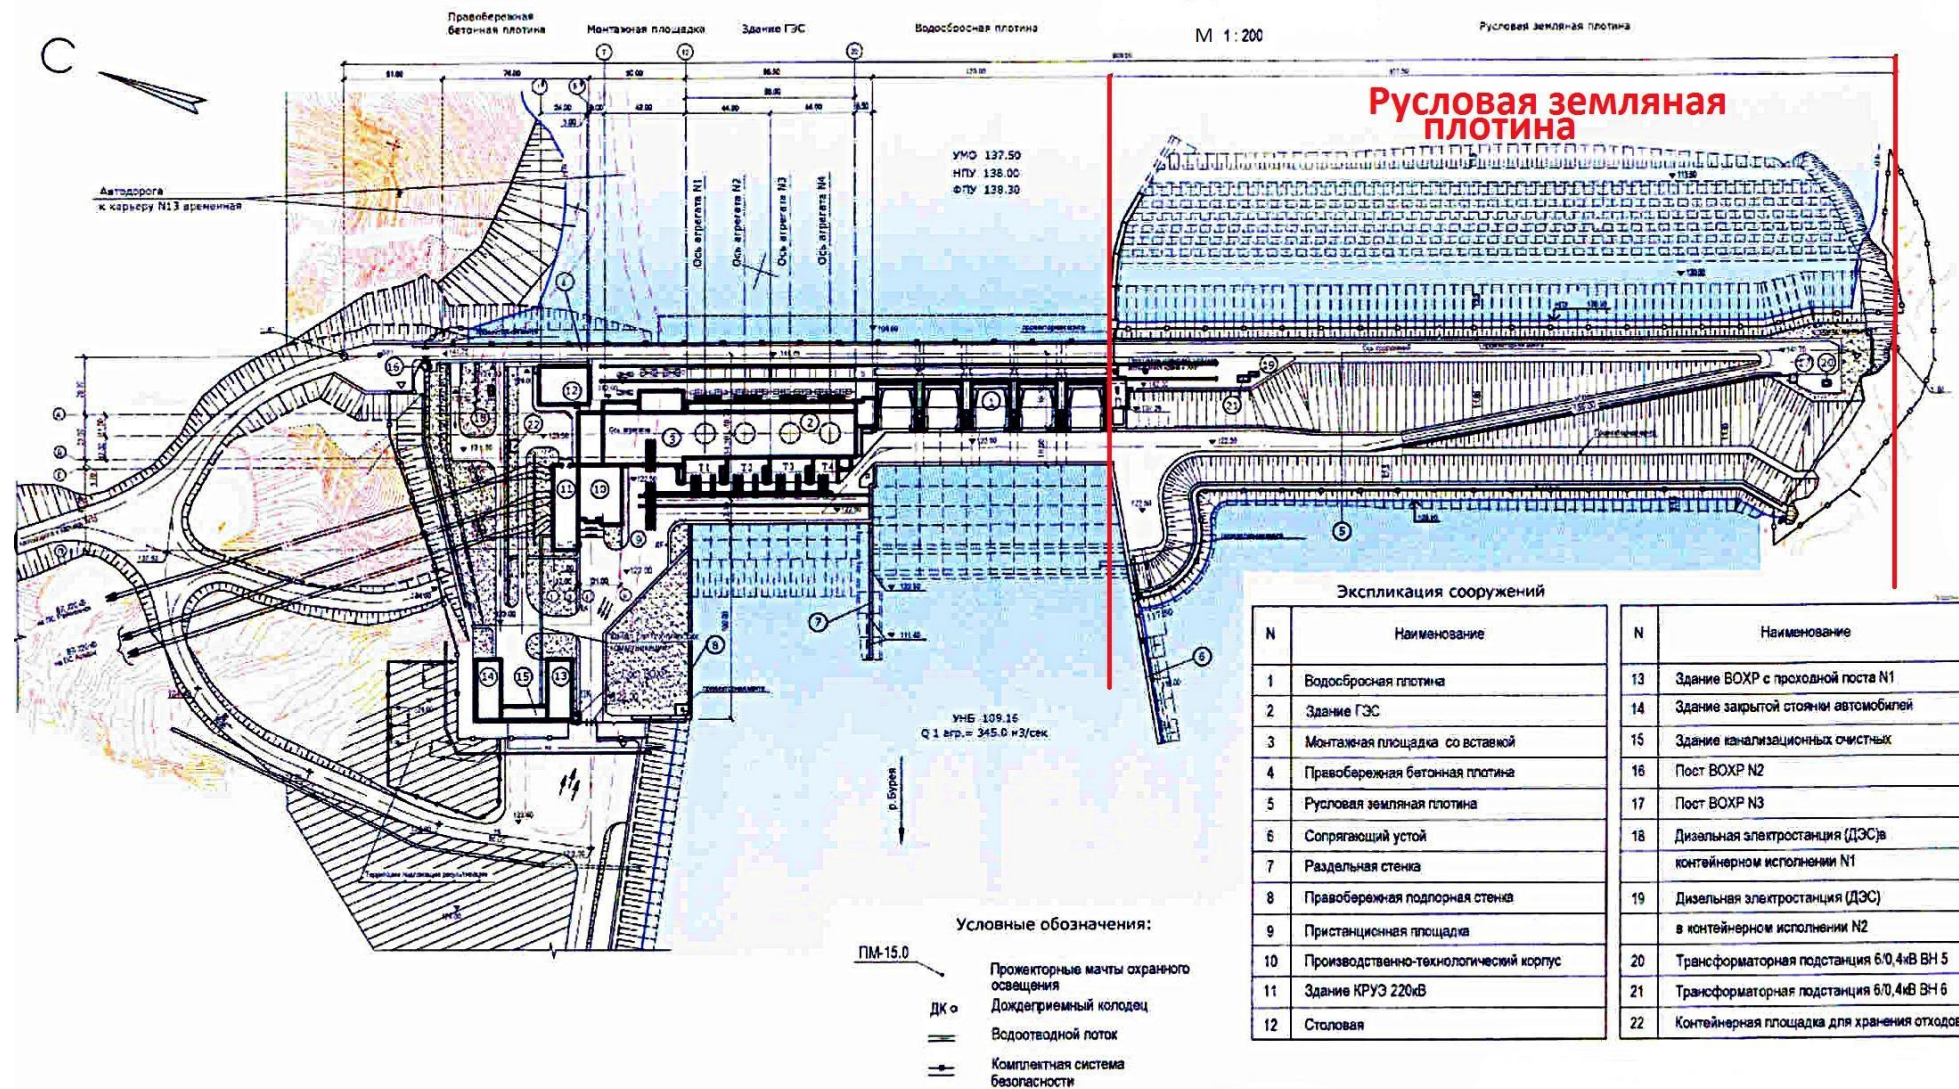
Генеральный план Нижне-Бурейского гидроузла (Отчет 1351, 2010)
